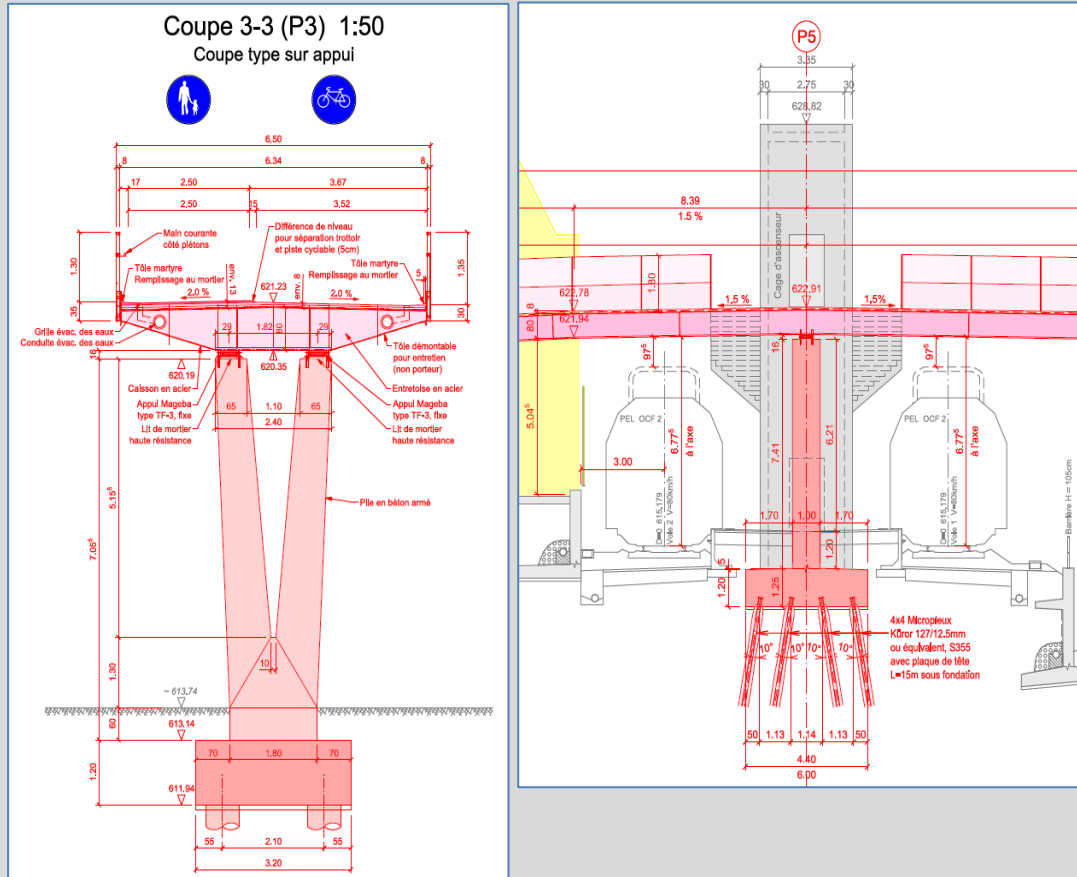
coupe type pile-passerelle et coupe longitudinale accroche escaliers et ascenseur, projet CFF, 9 avril 2018
